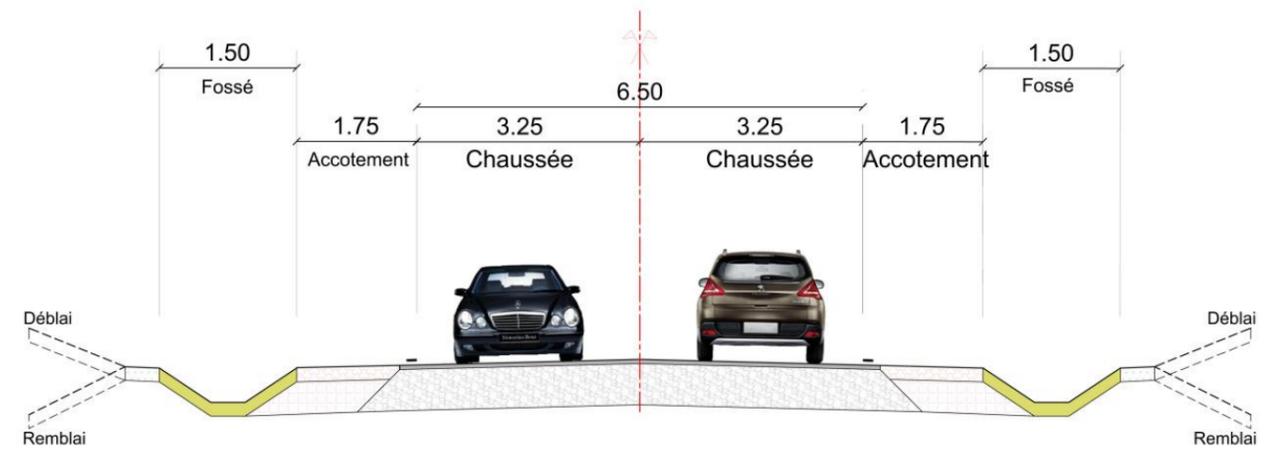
Coupe graphique du profil en travers de la section courante du contournement
